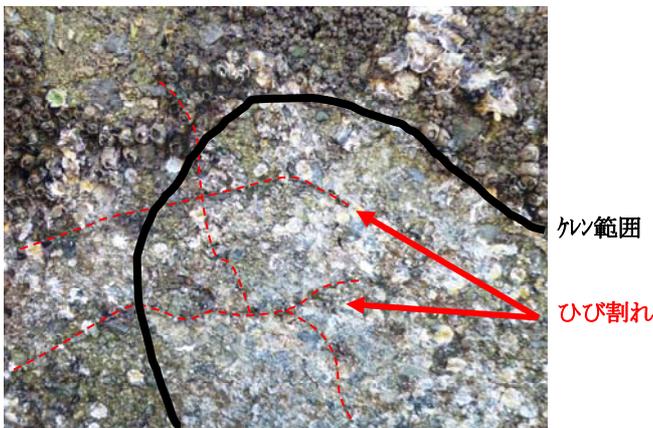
フジツボ下部のコンクリートひび割れ状況
